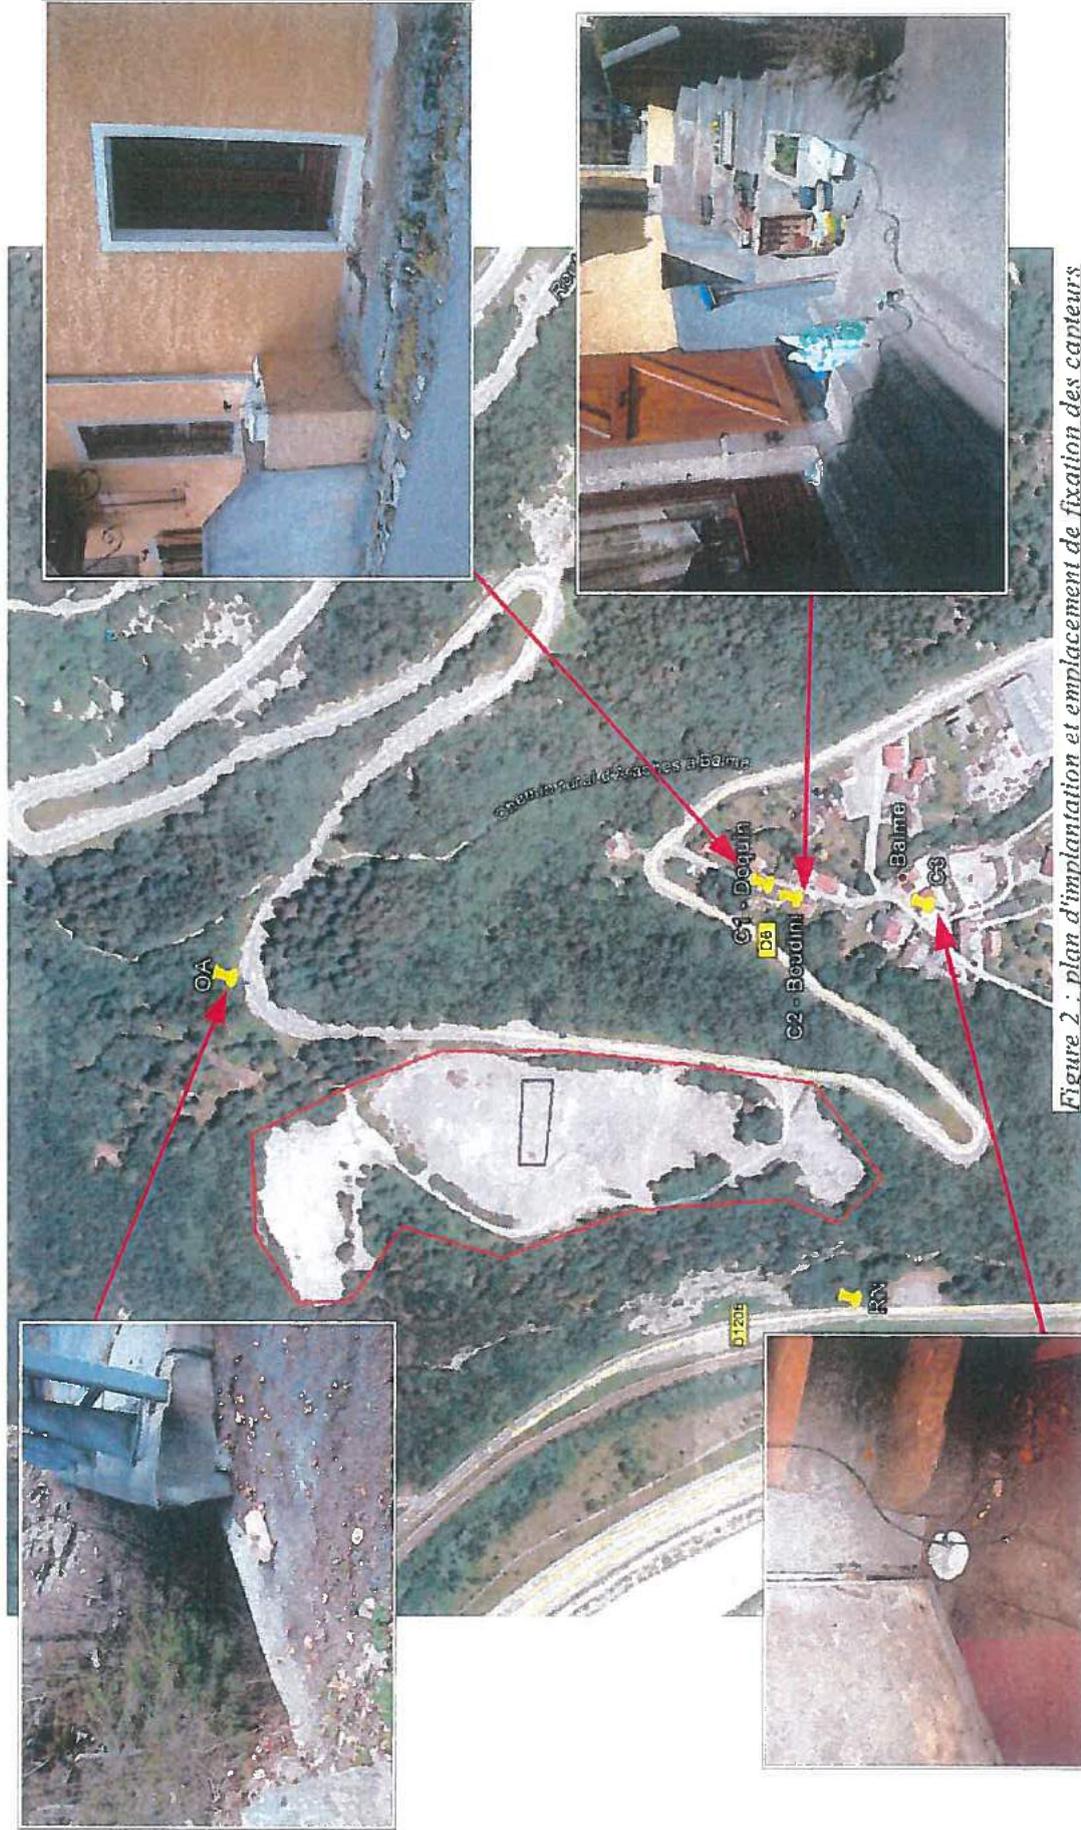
plan d'implantation et emplacement de fixation des capteurs
